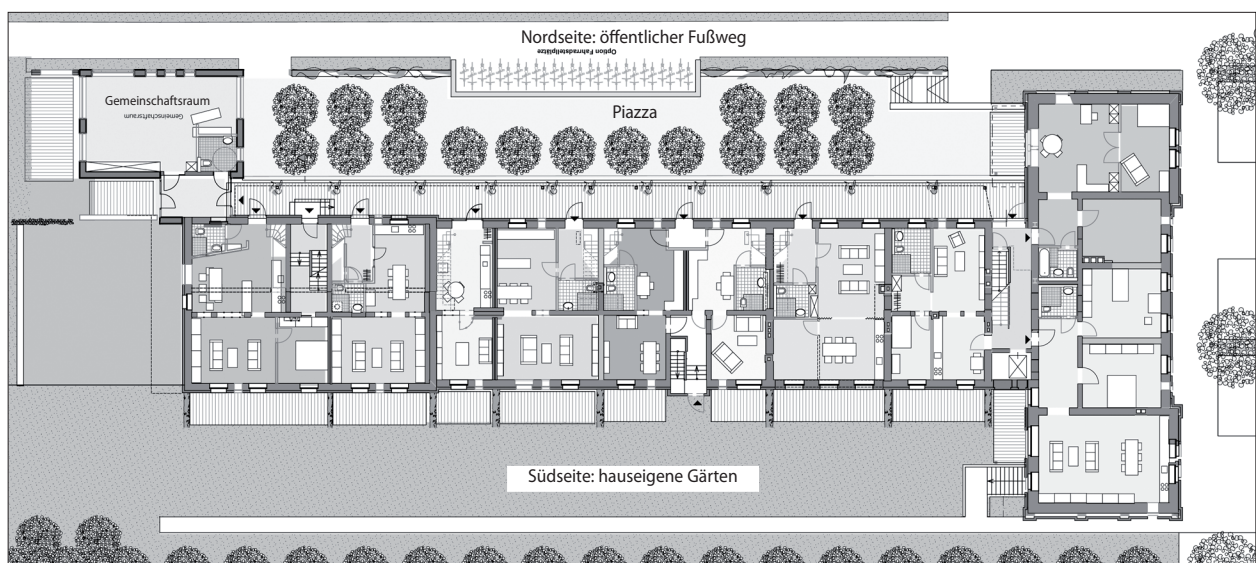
Erdgeschoss-Plan zum Wohnprojekt „buntStift“ in Bochum; im Nordwesten der am öffentlichen Fußweg liegende Gemeinschaftsraum [Quelle: Post-Welters Architekten und Stadtplaner, Dortmund / Köln]
